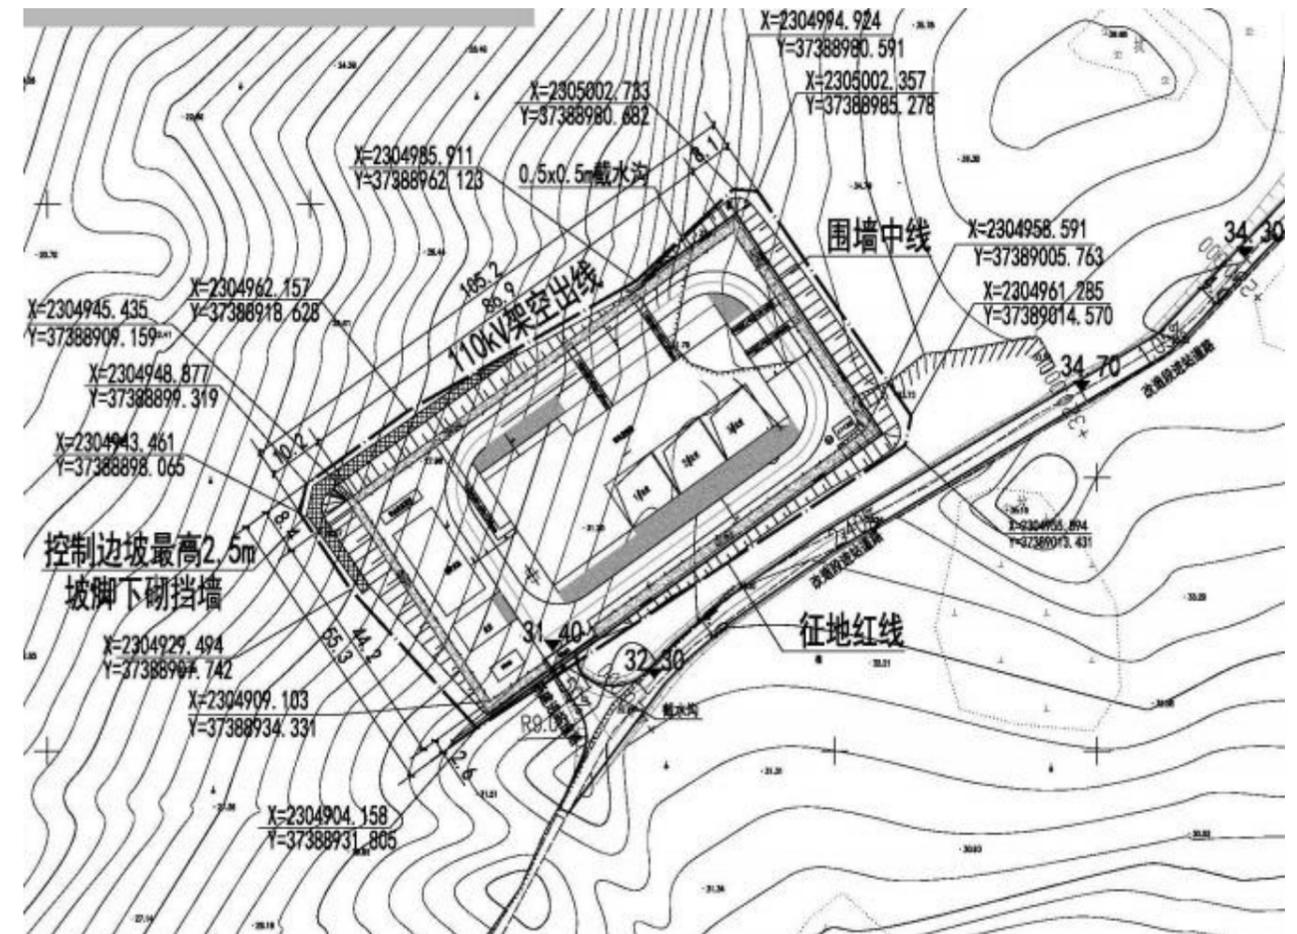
110 千伏竹桥站电气总平面布置图
